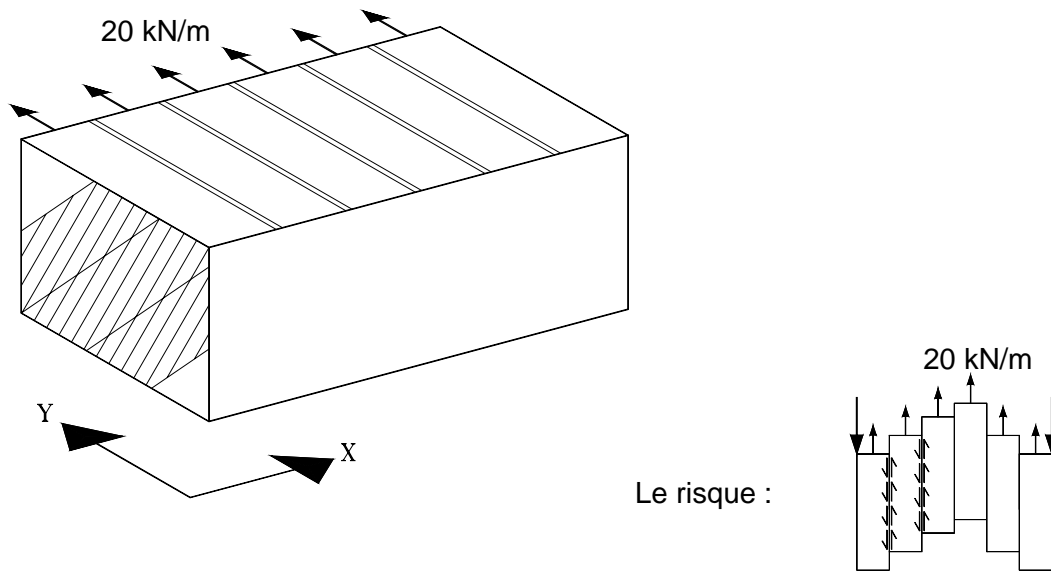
Plancher constitué d'éléments préfabriqués en béton. Reprise d'une action sismique de direction y
